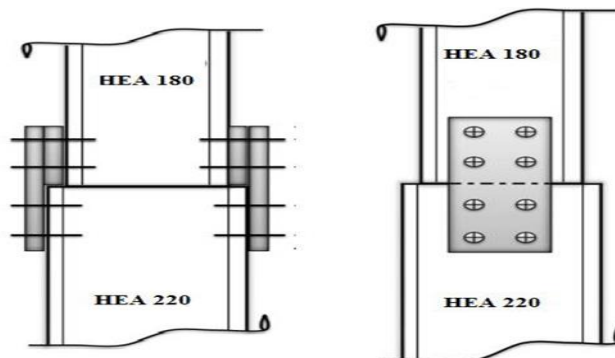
3: Assemblage poteau-poteau a section égale et section différente.
